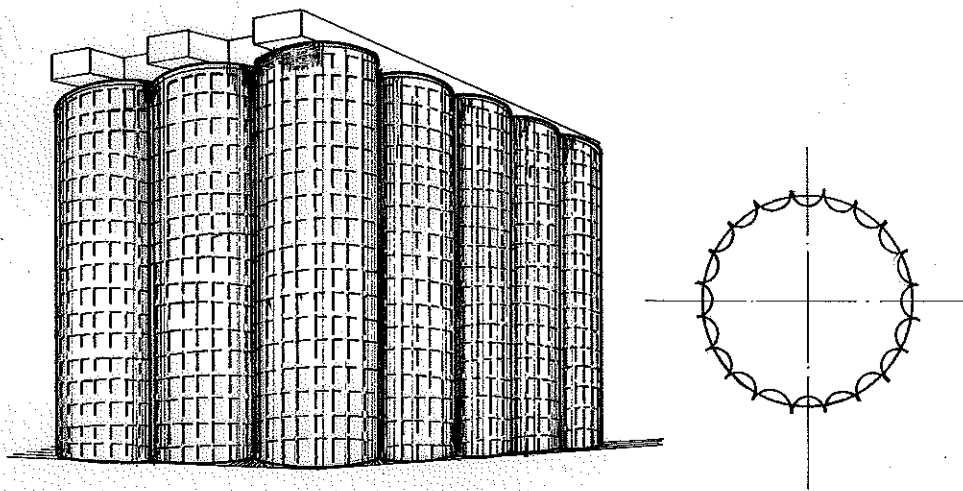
Silo de grandes dimensões pré-moldado com cascas cilíndricas (URSS).
